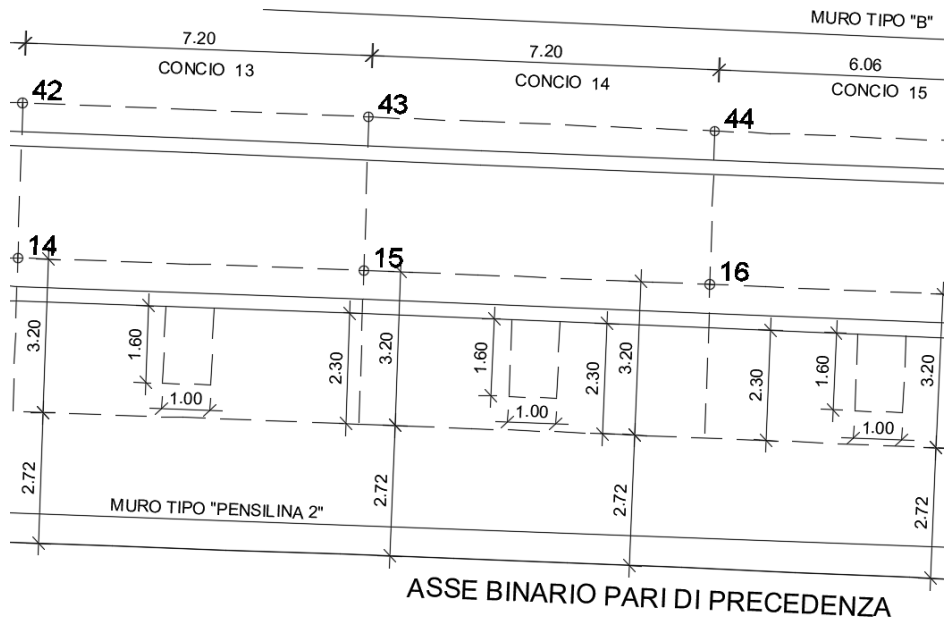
Stralcio planimetrico pensilina su "pensilina tipo 2 - FV01"
